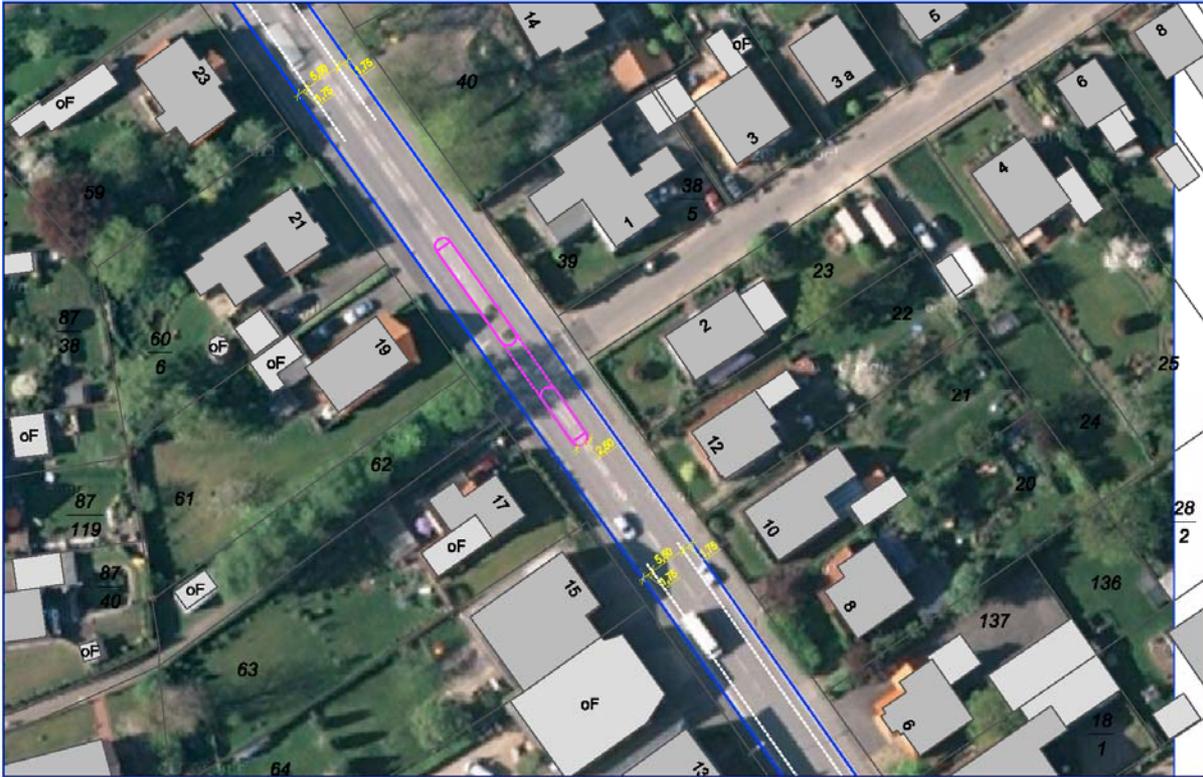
Ausschnitt Lageplan Jungfernstieg / Friedrichstraße (Blatt 3)
